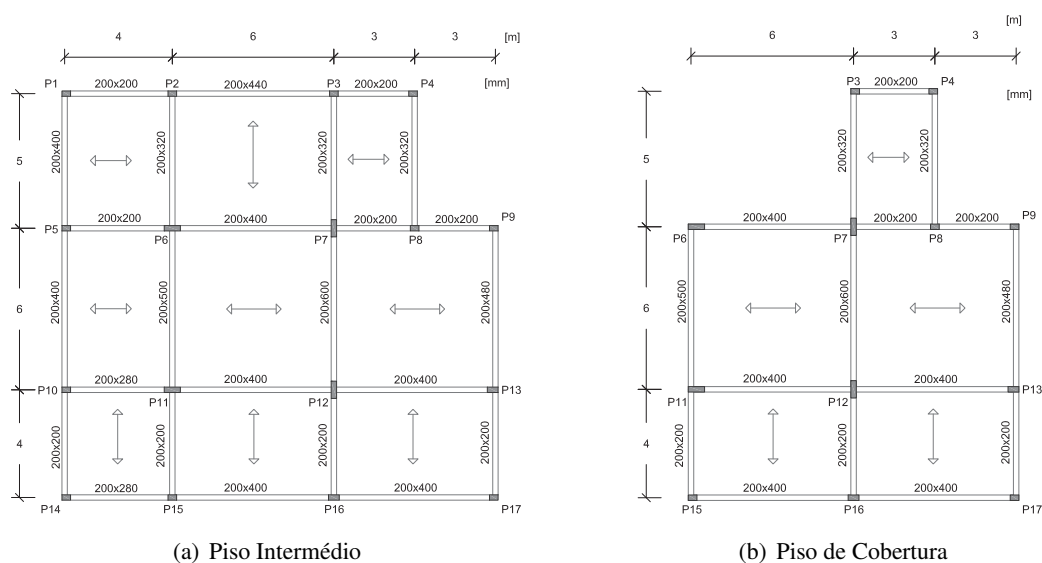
Planta estrutural referente à Solução Estrutural 3
